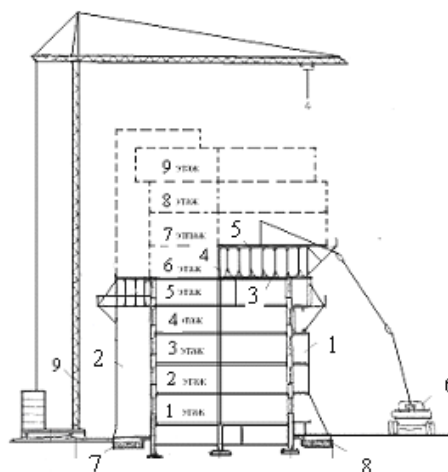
Технологическая схема пристройки монолитных пилонов, лифтовых шахт, вертикальных стен и перекрытий надстраиваемых этажей:
